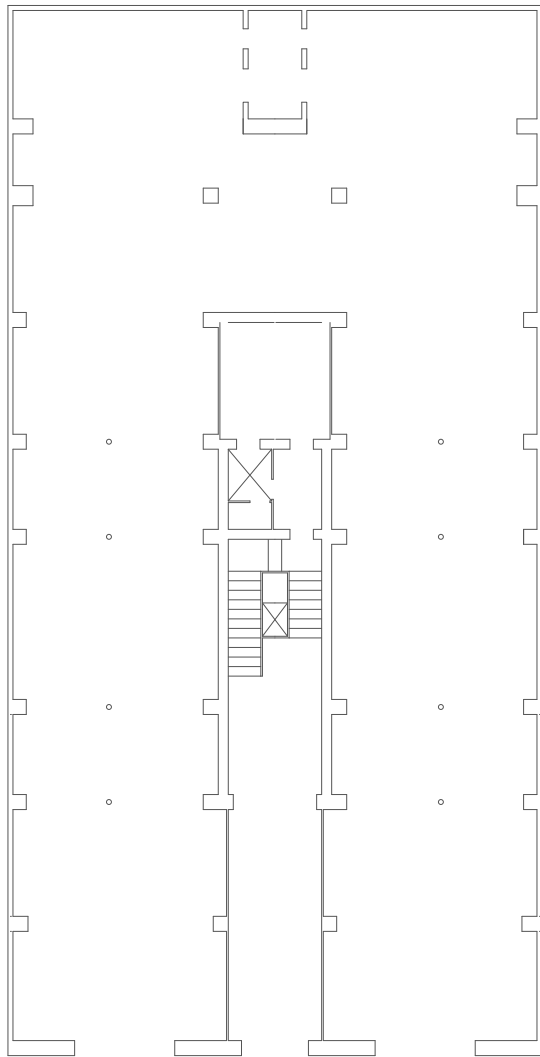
Vista en planta de PLANTA BAJA del edificio ED-01 (fuente: elaborado por el autor)
